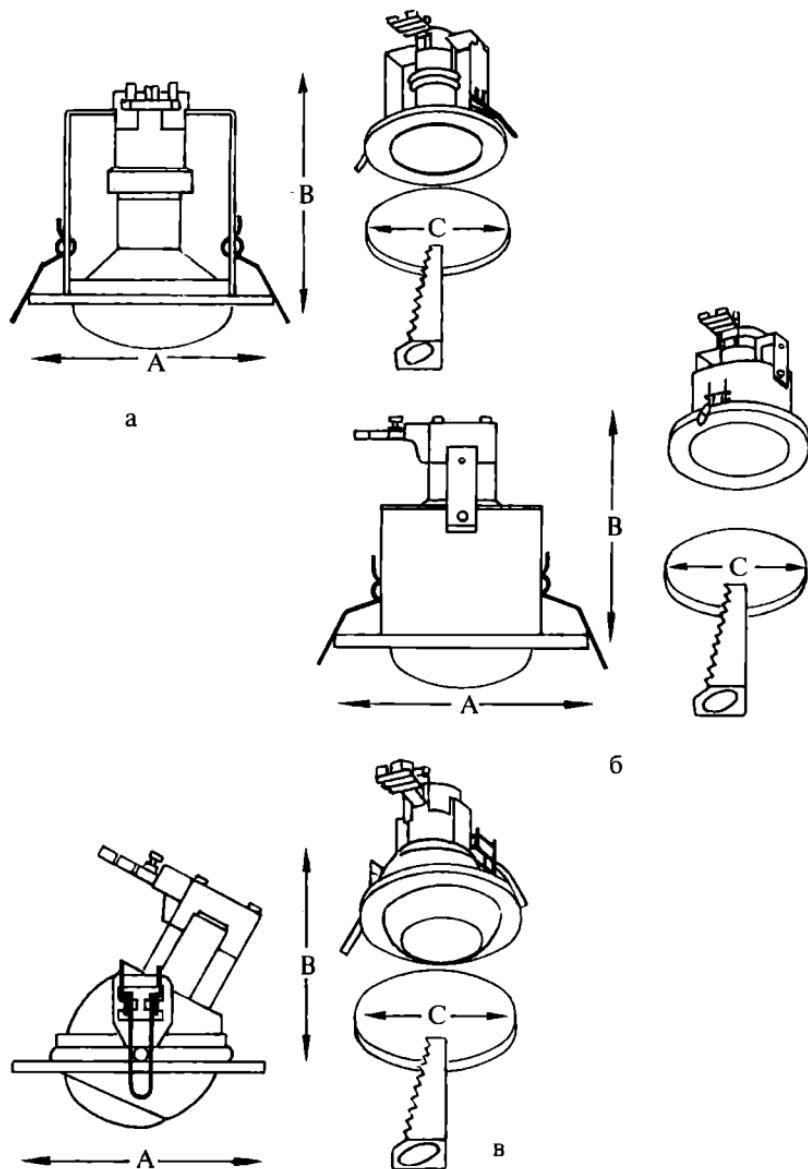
Типовые конструкции точечных светильников под лампу накаливания: а — поворотный светильник; А — внешний диаметр светильника; В — глубина установки; С — диаметр посадочного отверстия; б — неповоротный светильник; в — неповоротный светильник с защитным кожухом; А — внешний диаметр светильника; В — глубина установки; С — диаметр посадочного отверстия
